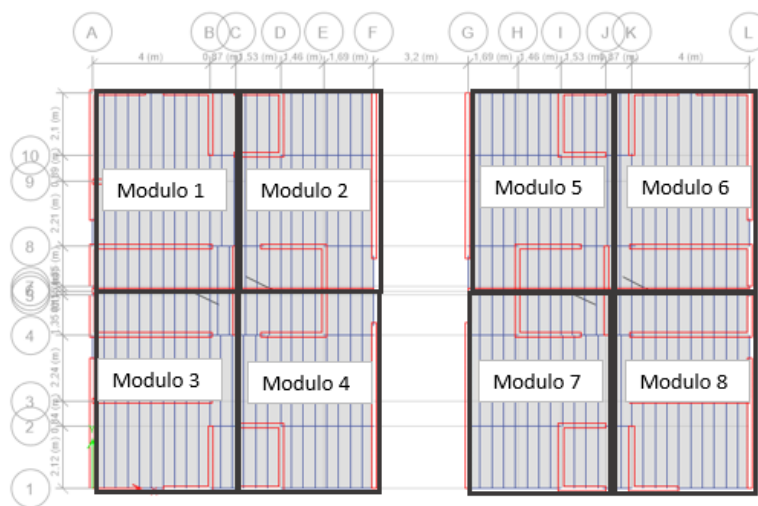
Separación por módulos edificio de madera, primera planta.
